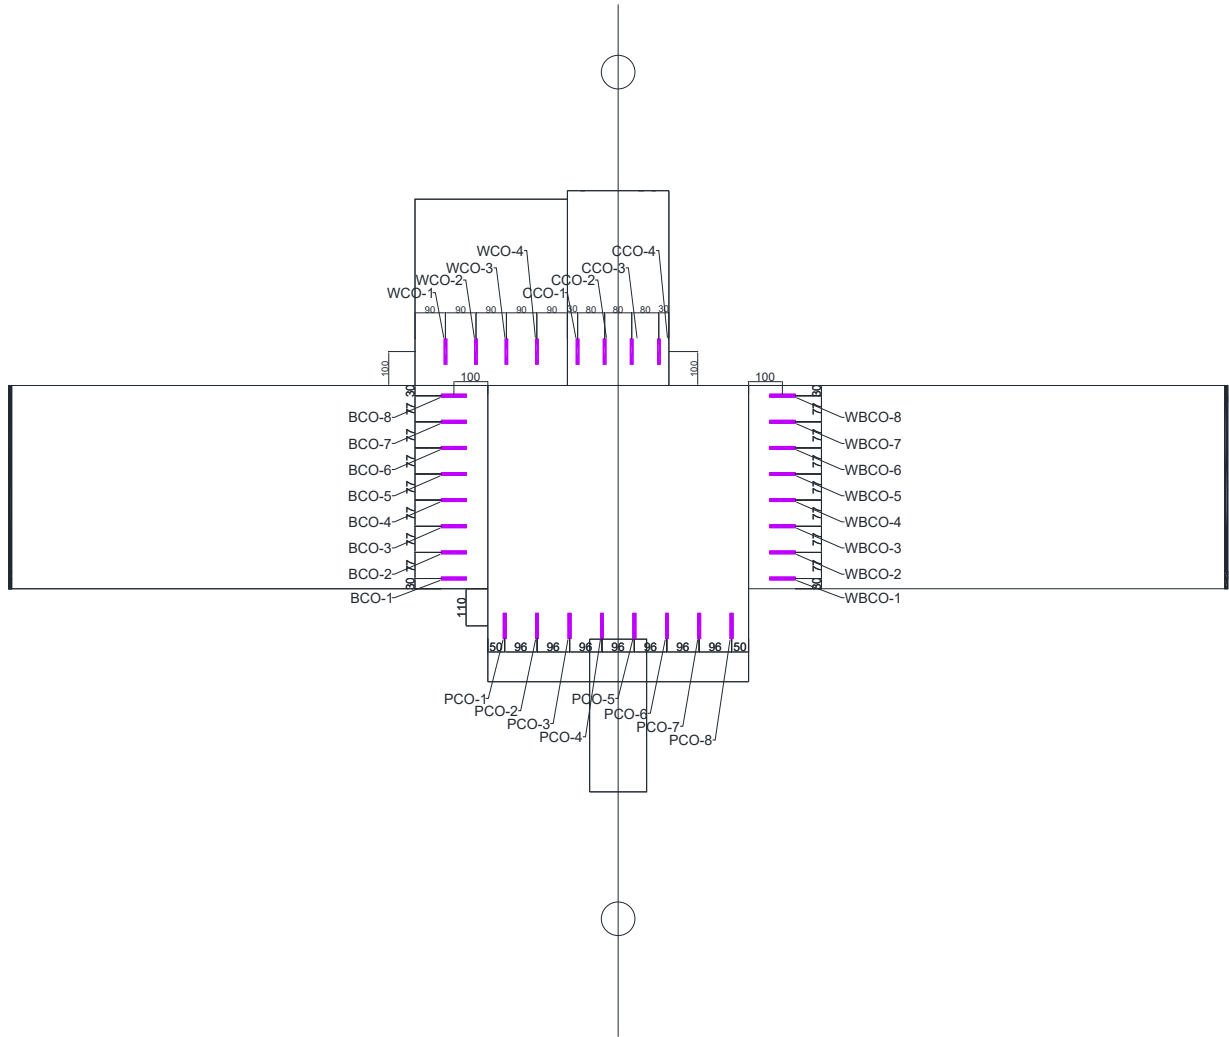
DR-5 コンクリートゲージ貼り付け位置
